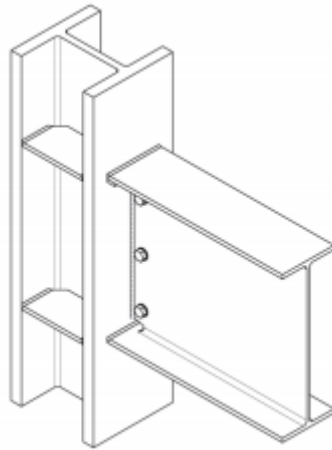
Conexión patines soldados sin refuerzos - alma soldada
